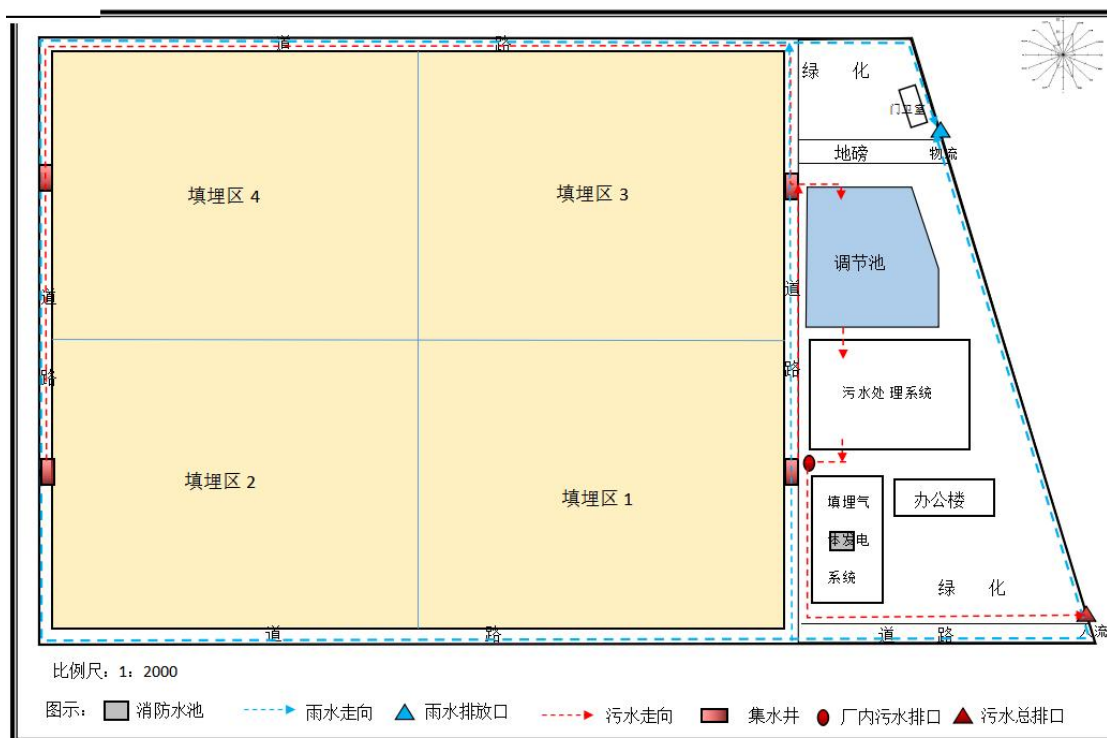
西平县城市生活垃圾无害化处理场平面布置图
